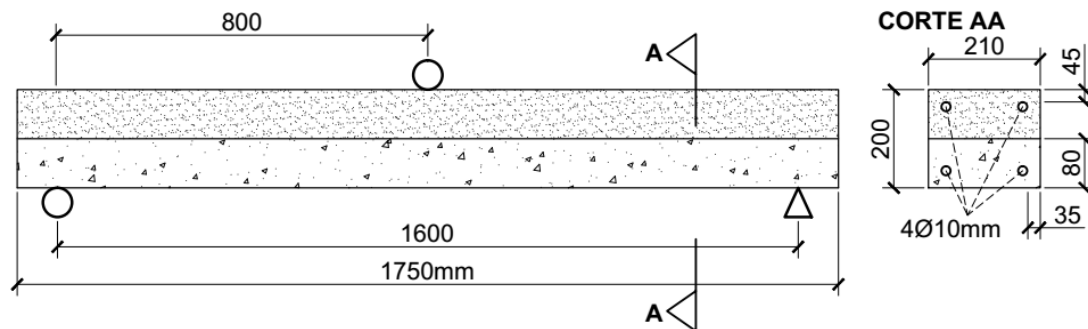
Detalhamento das vigas ensaiadas (PEREZ *et al.*, 2008).
